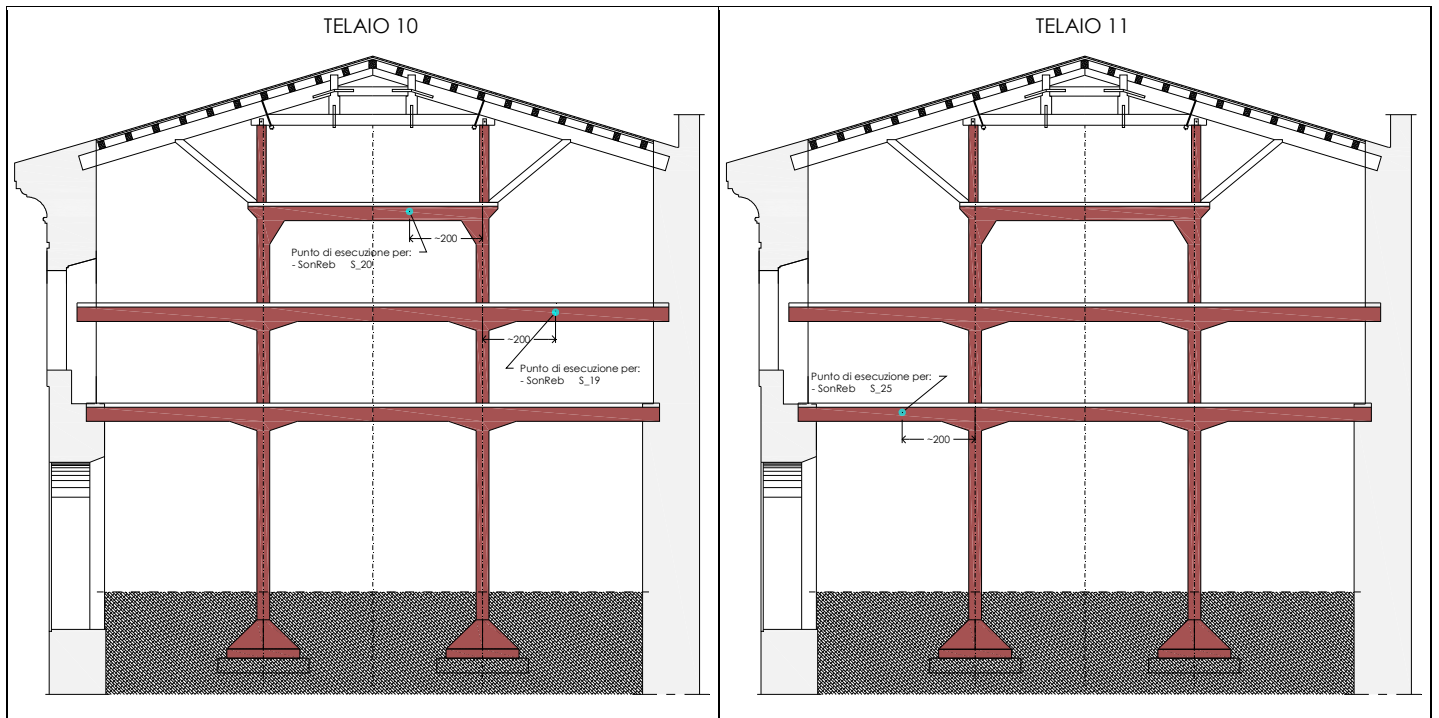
Posizione delle prove SonReb sui telai 10 e 11
